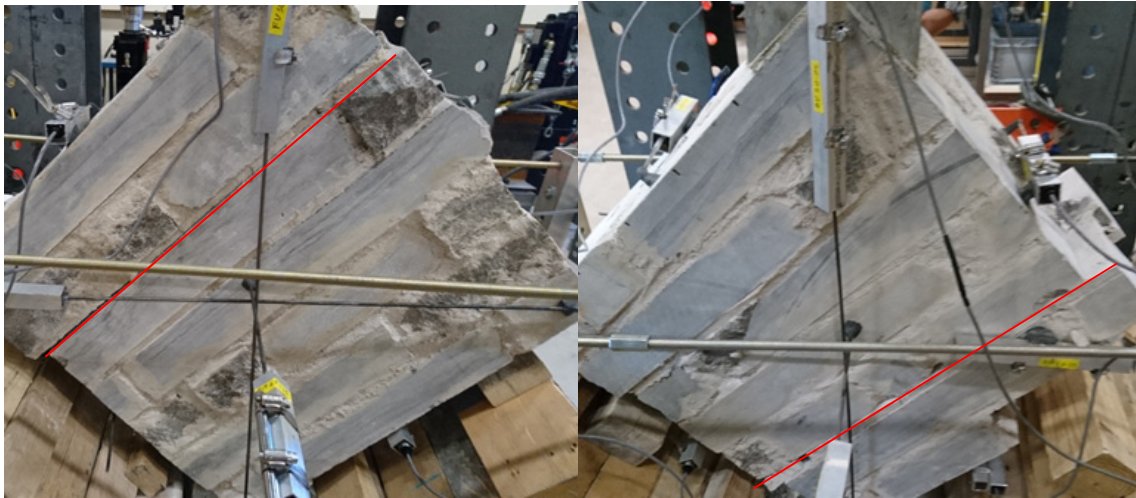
Fissuration des spécimens suite aux essais de traction diagonale
